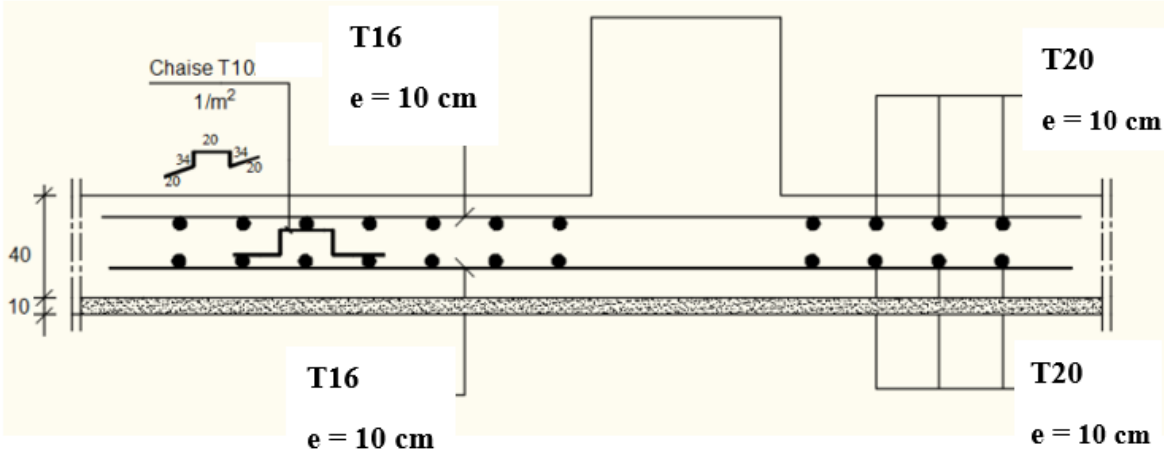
Dessin de Ferrailage de la dalle du radier.
